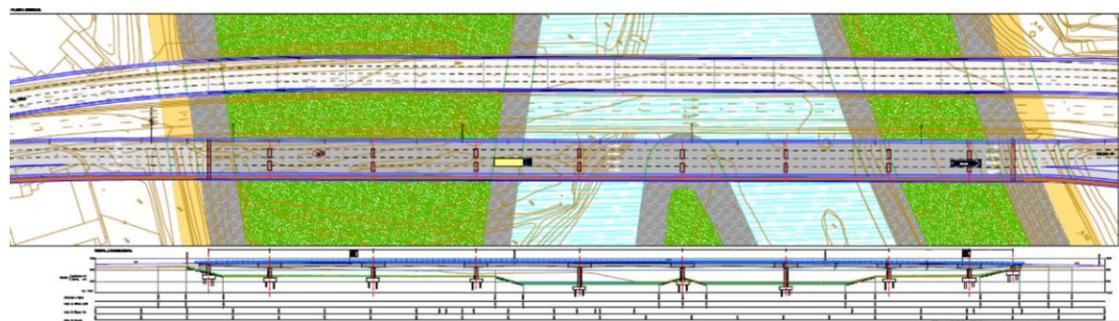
Planta y perfil de una de las alternativas estudiadas en el proyecto
